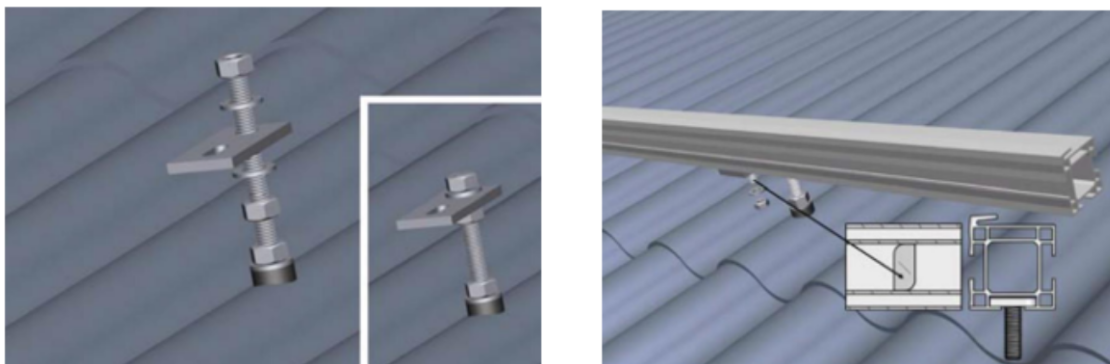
Système de montage sur plaque ondulée ou nervurée
